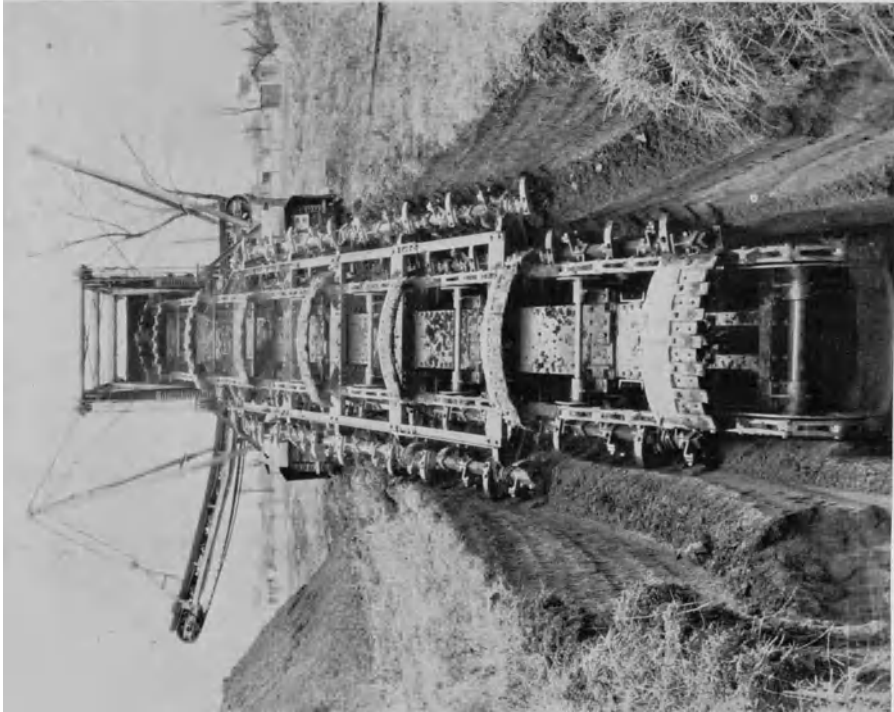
Buckeye-Grabenbagger mit doppelten Messerwellen.
